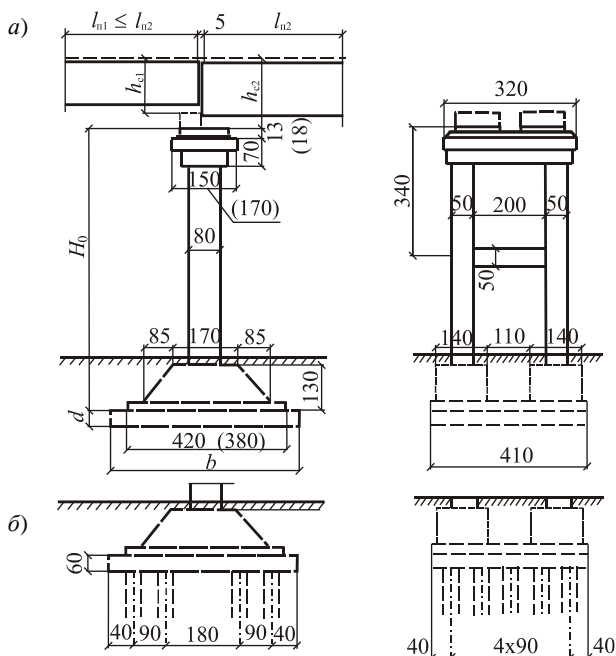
Схема опор: *a* – опора под езду поверху с фундаментом на естественном основании; *б* – вариант свайного фундамента (размеры в скобках – при $l_{n2} > 18,7$ м)
